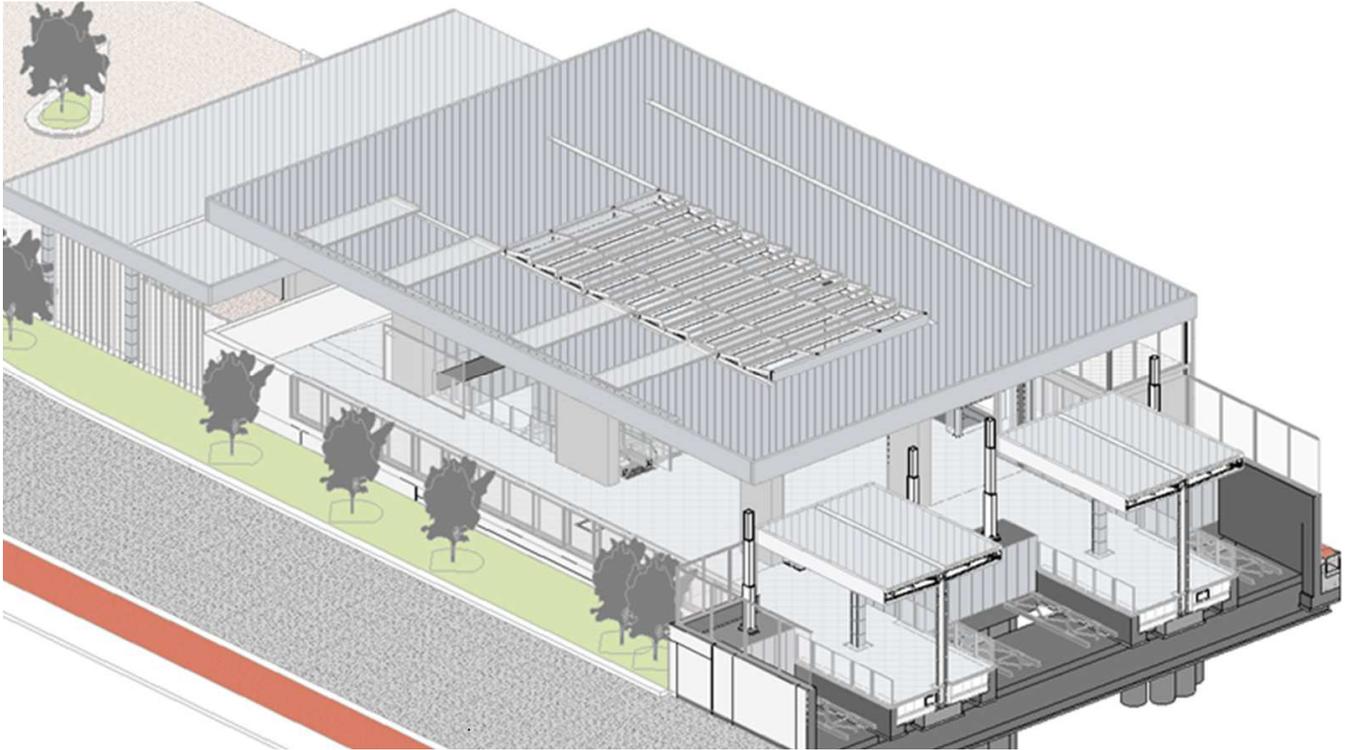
Vista assonometrica FV01 – Copertura principale e Copertura Bike Box fronte nord
